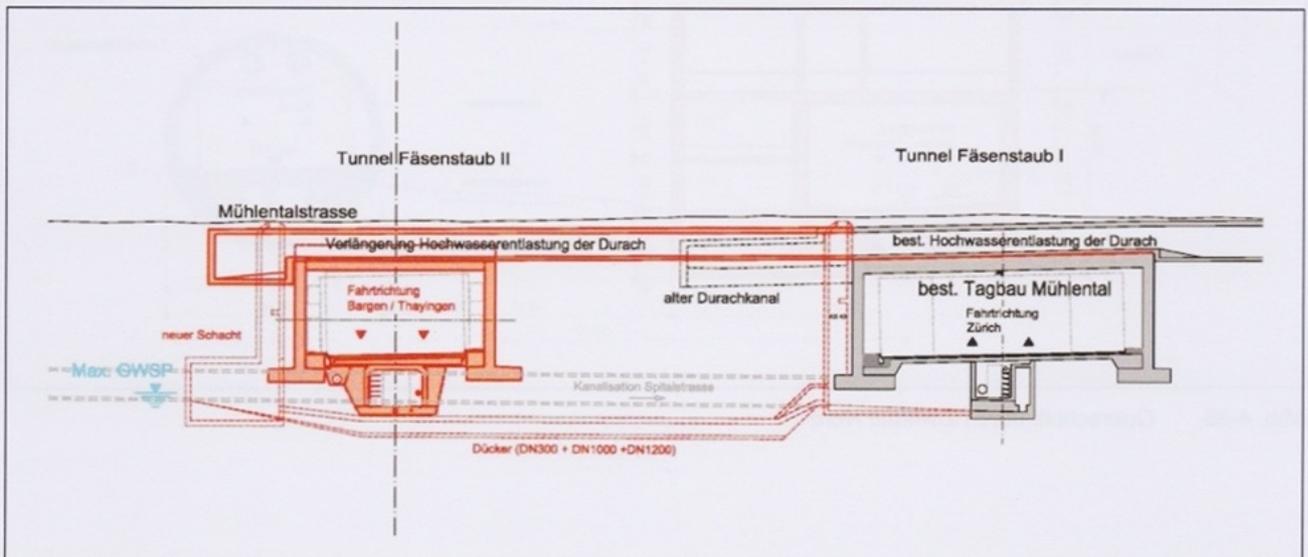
Verlängerung der Hochwasserüberleitung über den Tunnel Fäsenstaub II mit lokaler Einschränkung des verkehrstechnischen Nutzraums auf 4.8 m und Dückerkonstruktion
